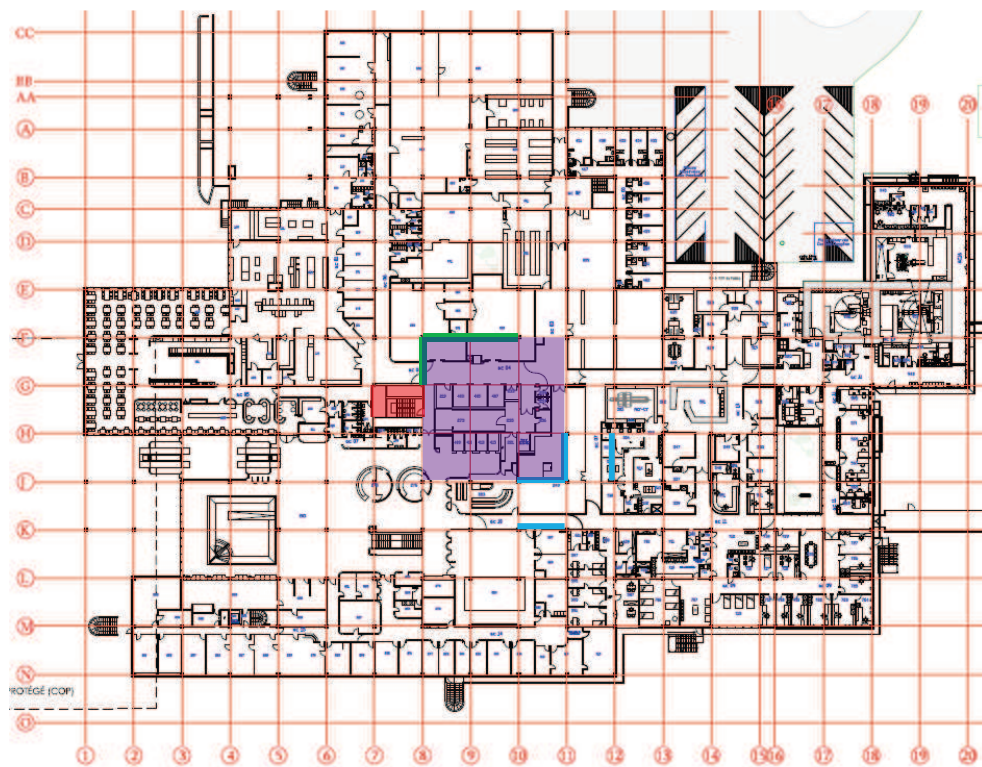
Plan du rez-de-chaussée, niveau A. Nouveaux murs en béton armé.
